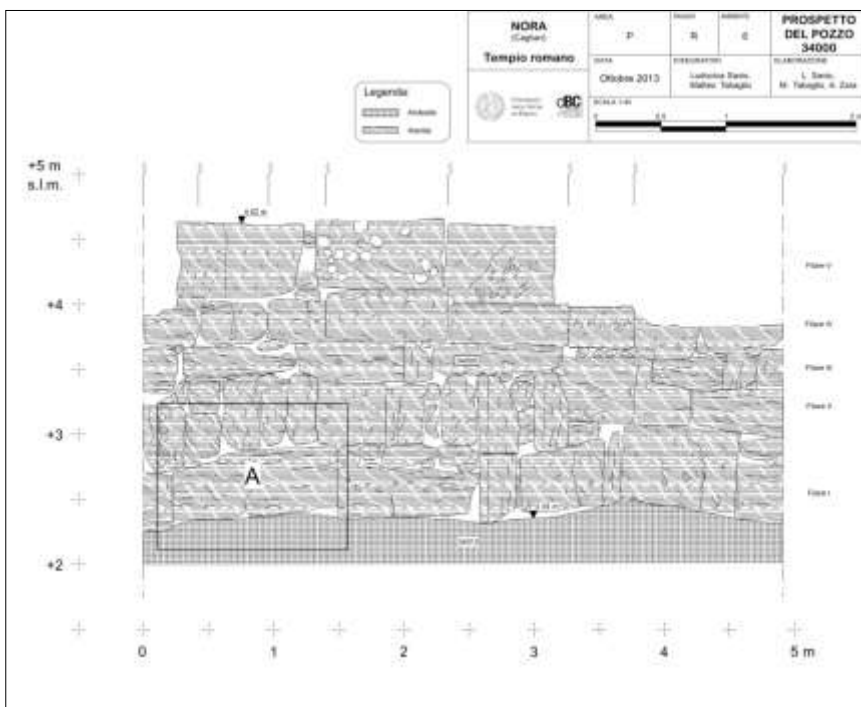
Prospetto delle pareti del pozzo 6 (da Savio 2014, p. 178).
